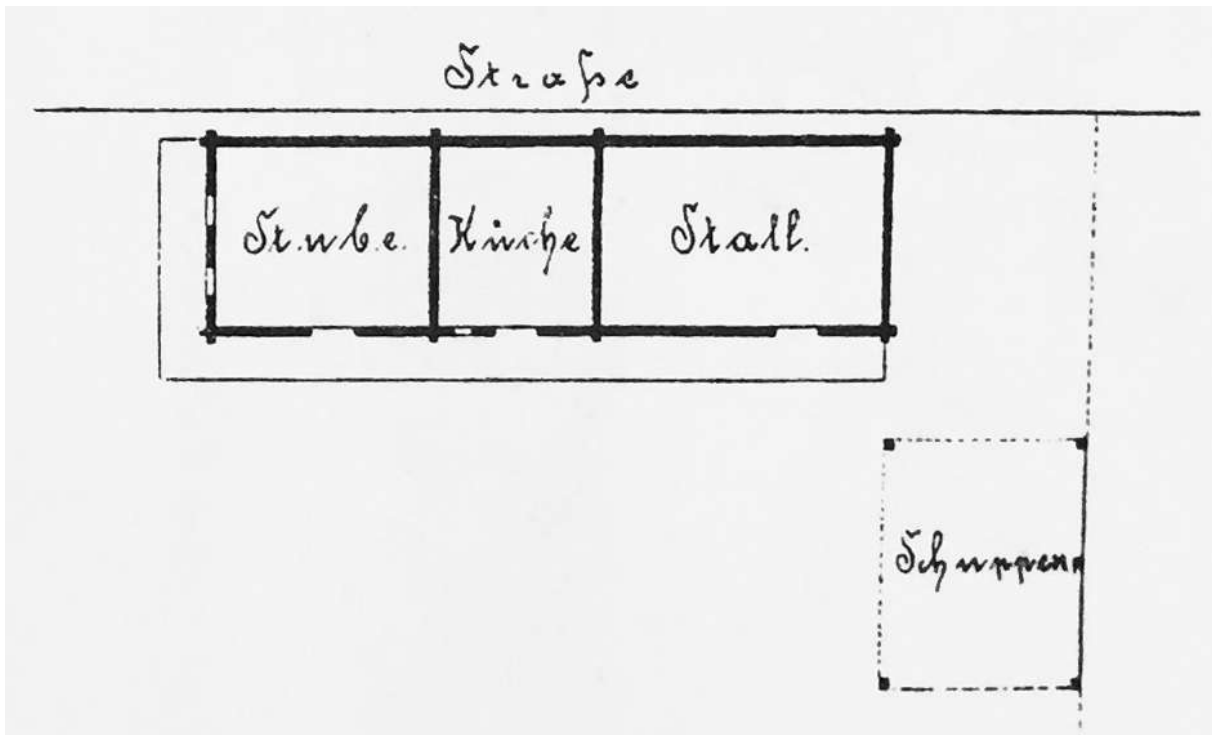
Grundriss eines dreiräumigen Wohnstallhauses, 1895
